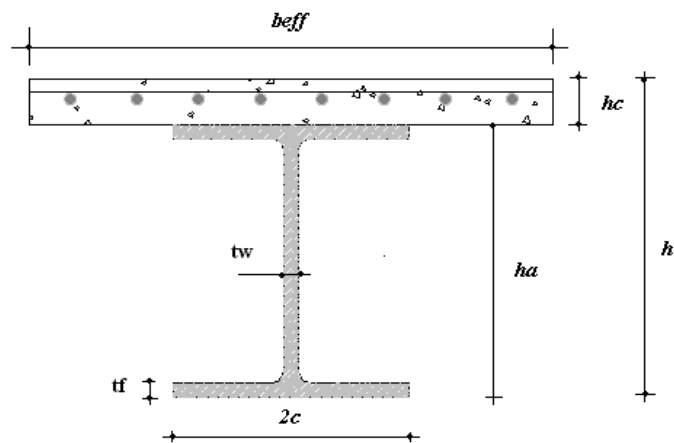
notation adopter pour le calcul des poutres mixtes
